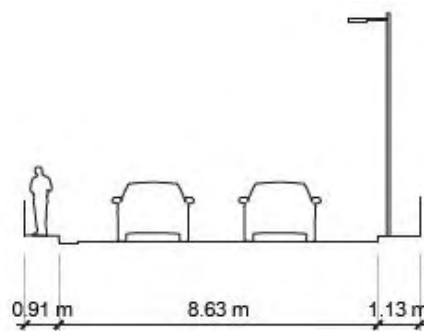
Sezione attuale Via Ponte Cavalcavia Ponticelli
